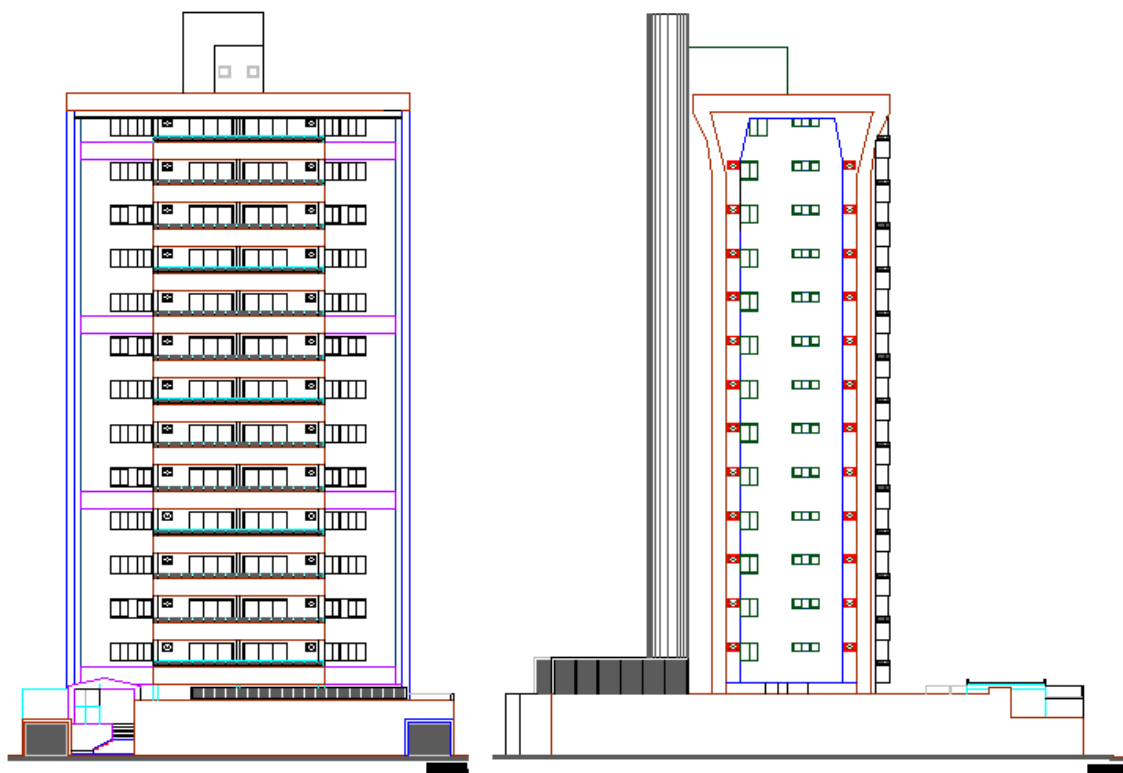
Elevação - Fachada Frontal e Fachada Lateral Esquerda
